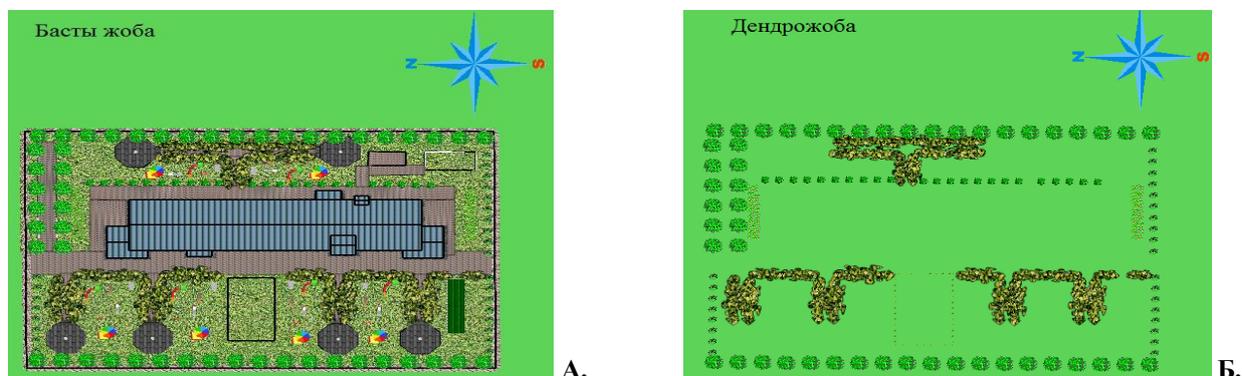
А – генплан детского сада, Б – дендроплан детского сада
